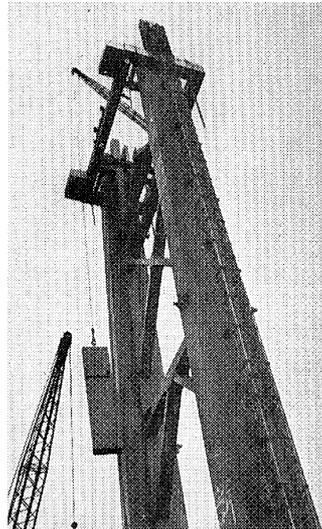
Forth Road 橋の架設クレーン (神戸市調査月報)
